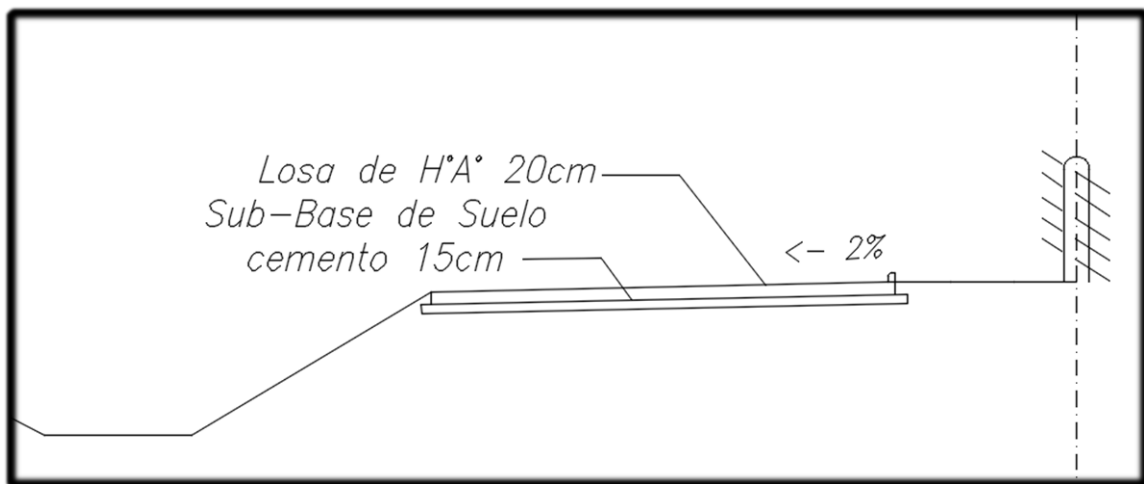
Esquema del paquete estructural del pavimento rígido.
